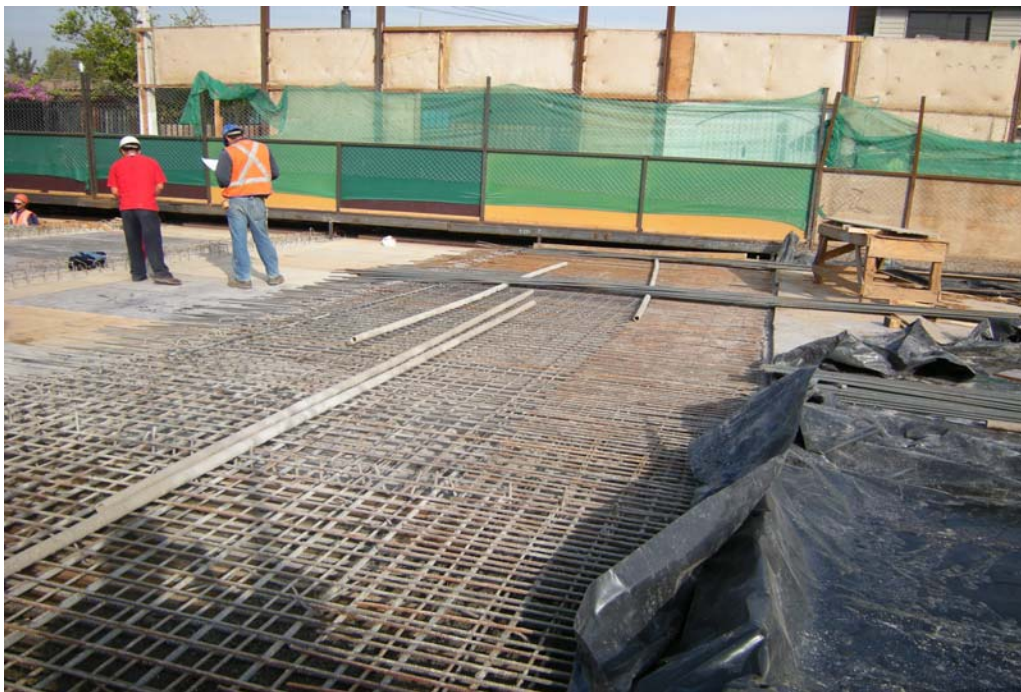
Inicio Armaduras del Tramo. En esta foto se aprecia la armadura de la losa puesta en la mitad de la losa de control.
